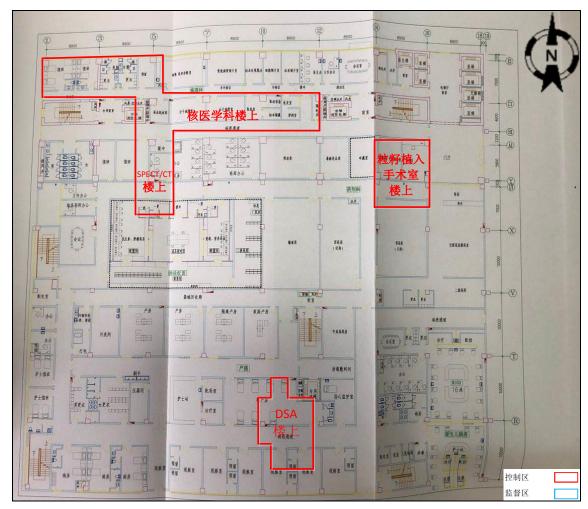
本次竣工环保验收项目楼上(住院楼二楼)平面布置示意图
